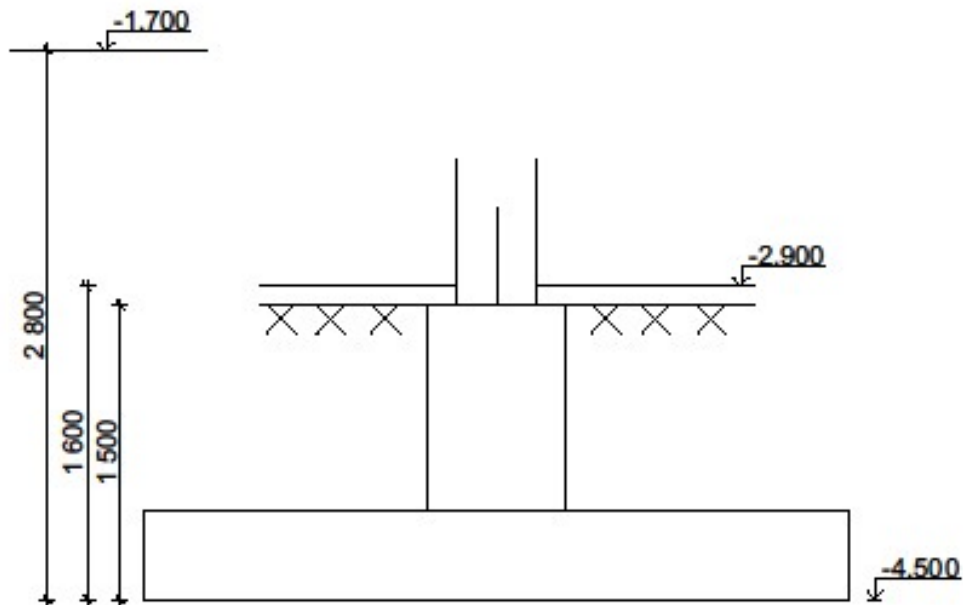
Положення фундаменту мілкого закладання у ґрунті
